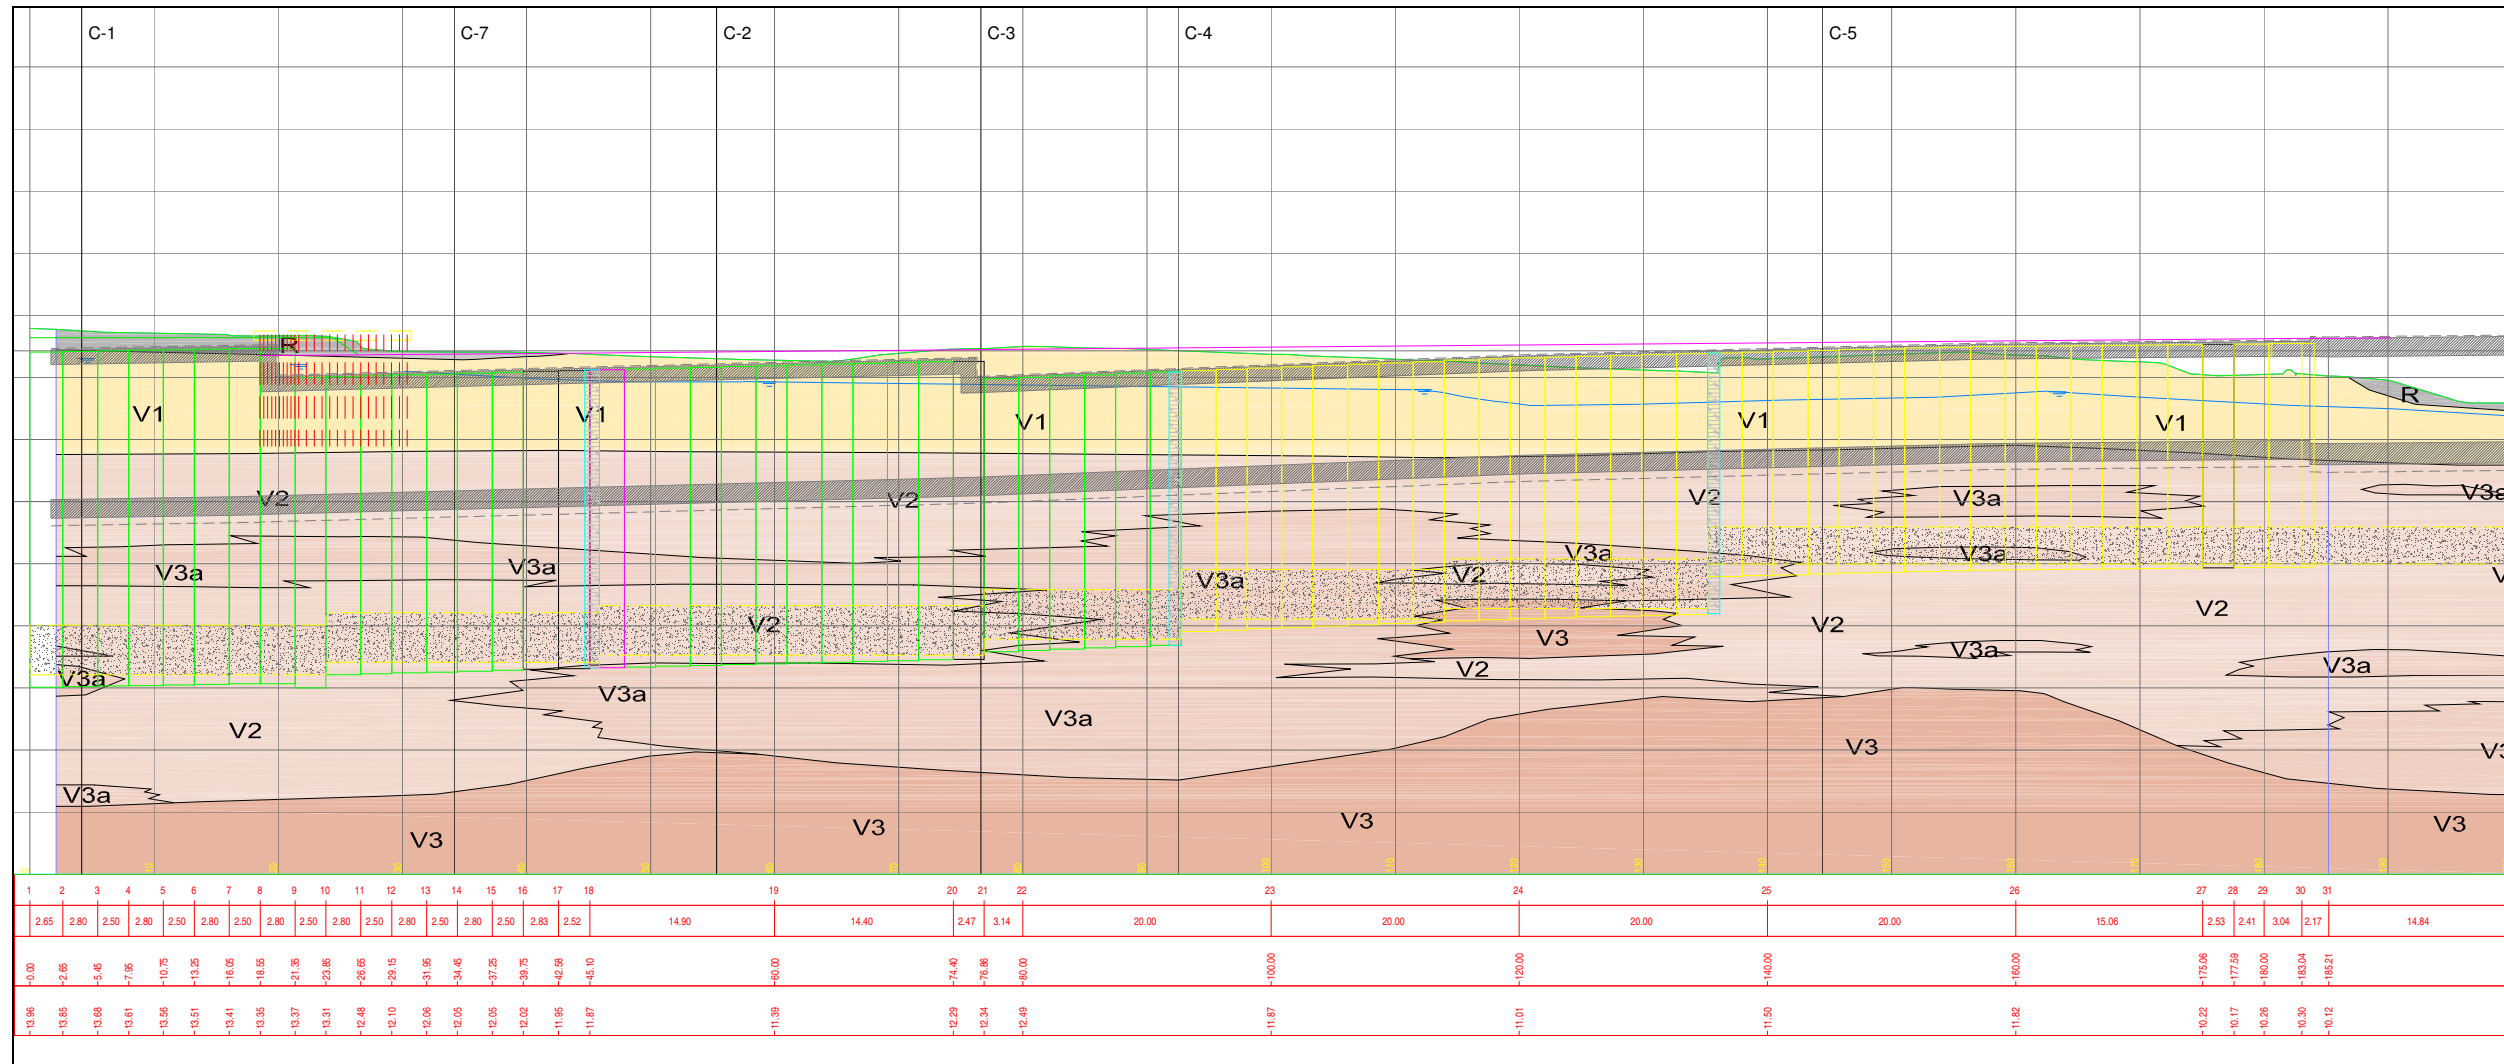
Sezione geotecnica longitudinale con traccia delle sezioni trasversali
